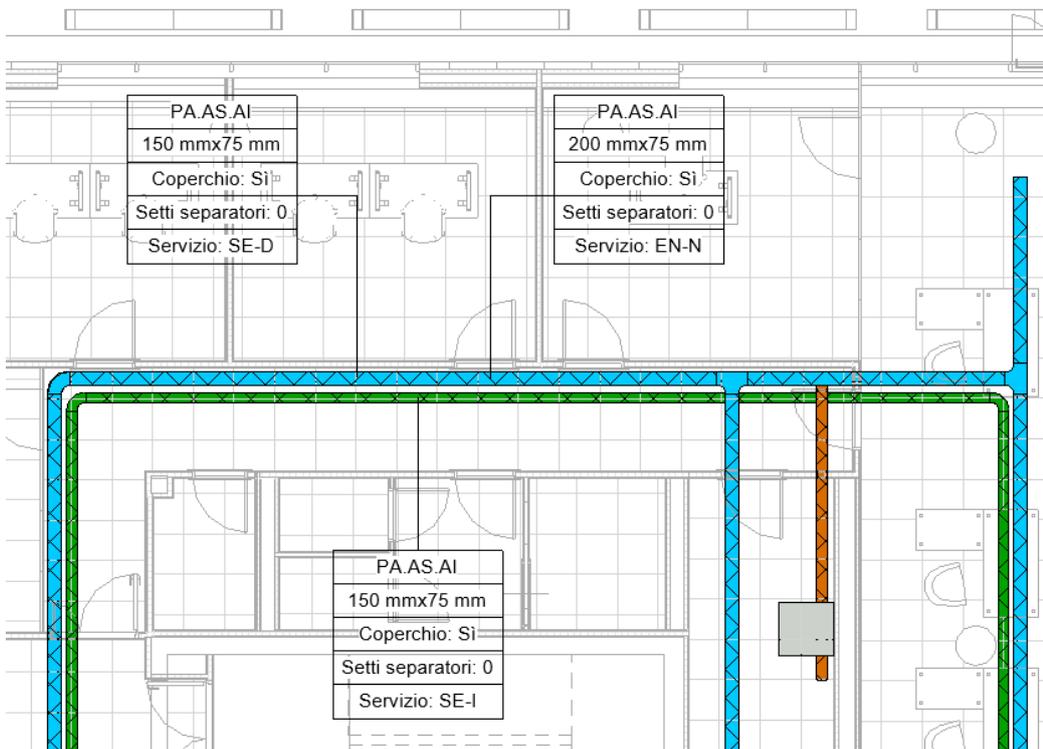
Vista in pianta della distribuzione a soffitto con etichette senza quota
